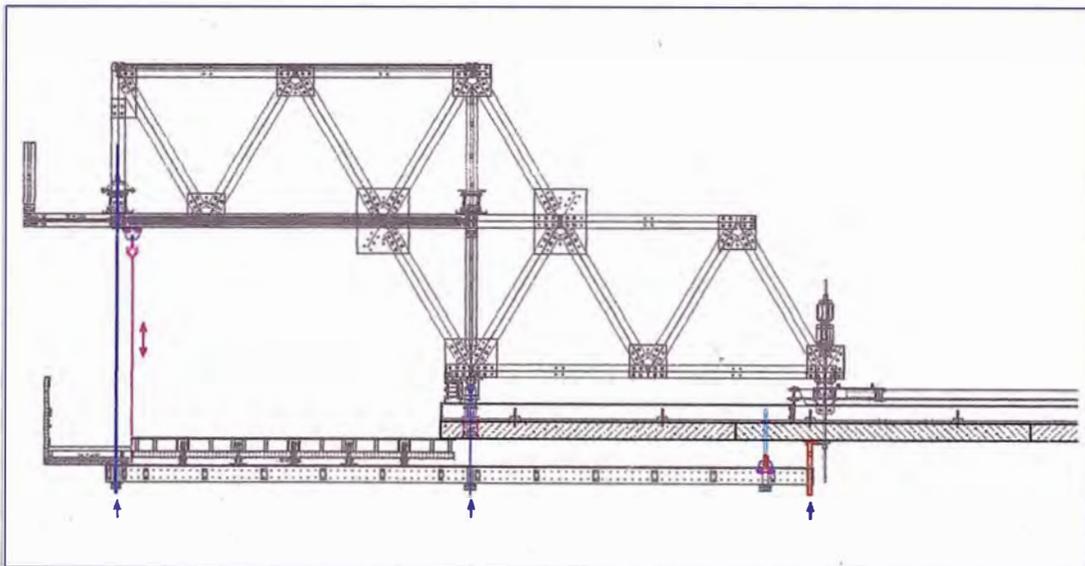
Posición final del encofrado interior - Fuente: Elaboración Propia
